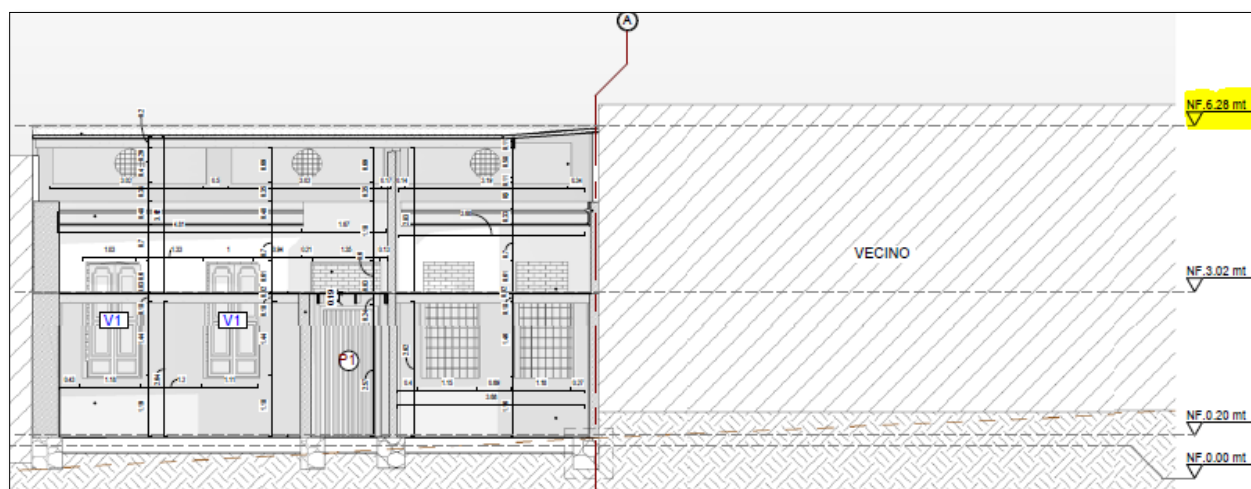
Corte arquitectónico – detalle niveles Salón Comunal
